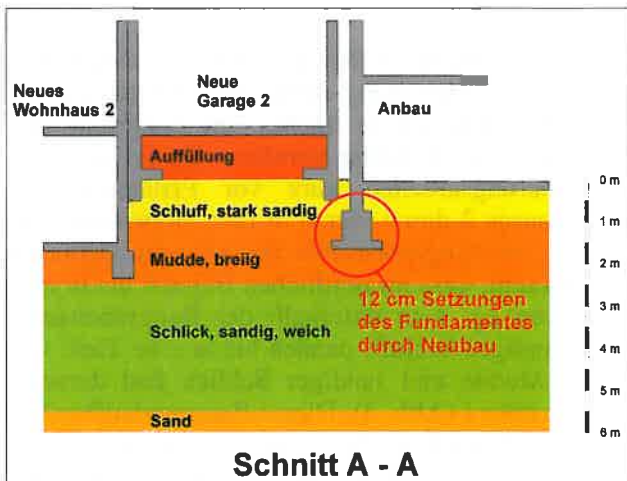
Schnitt A-A gemäß Abb. 2 inkl. Baugrundaufbau
